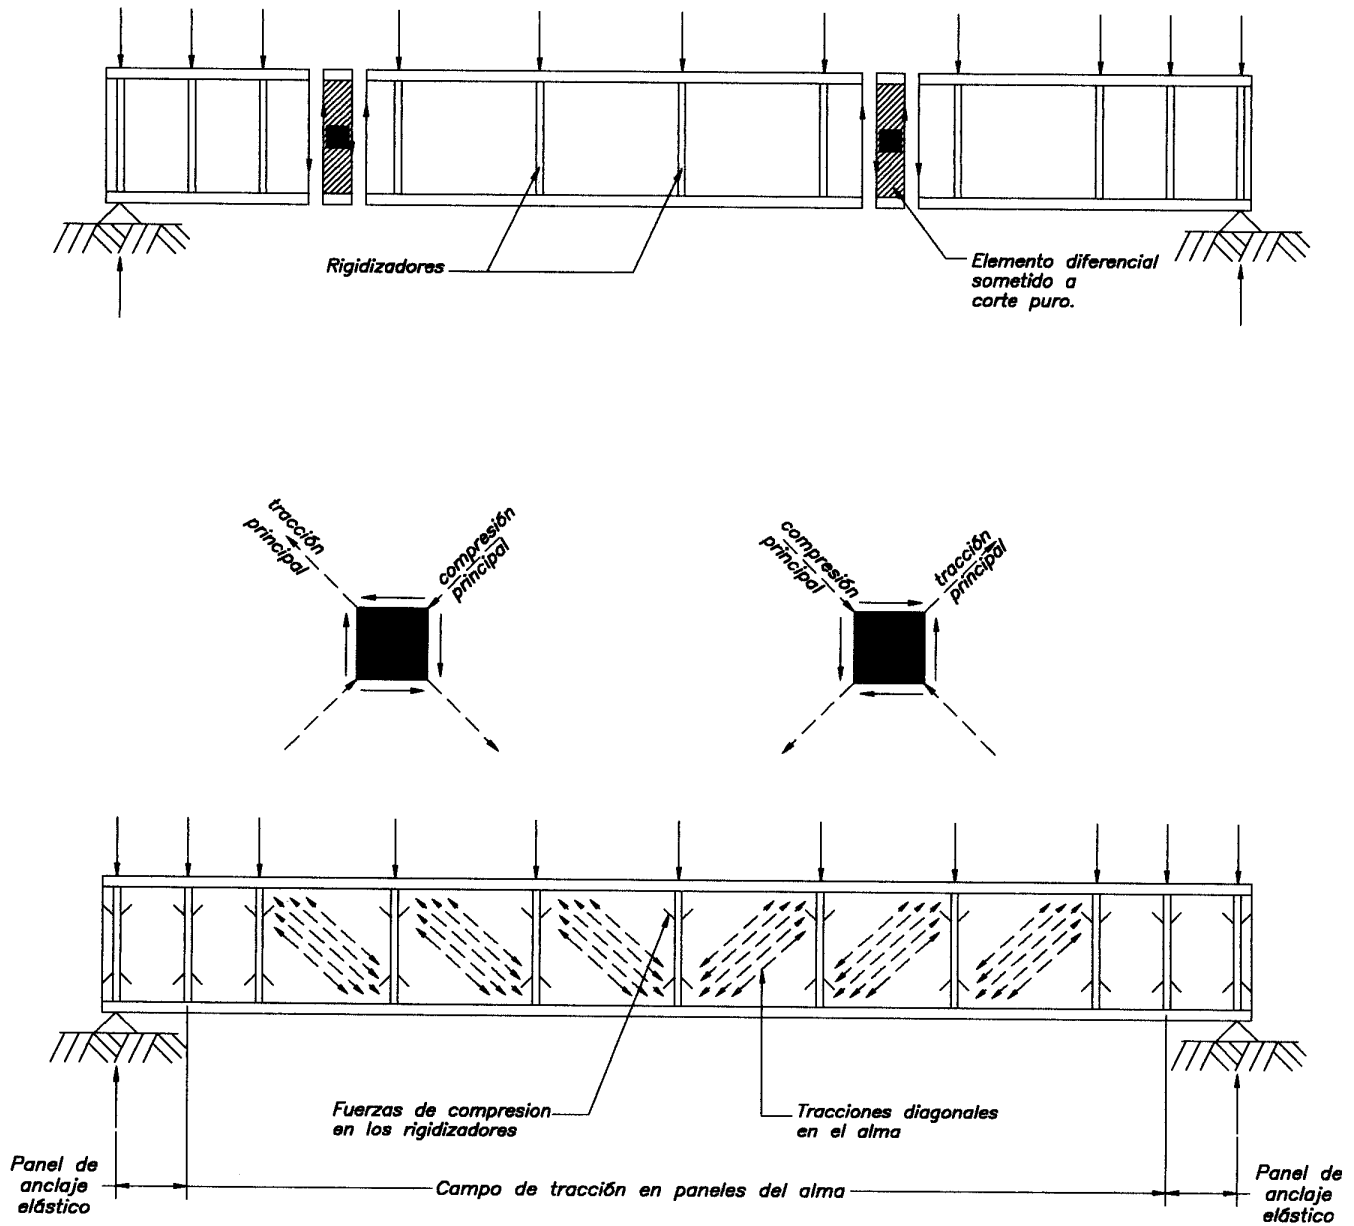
Ilustración de la acción del campo de tracciones diagonales en una viga armada.
